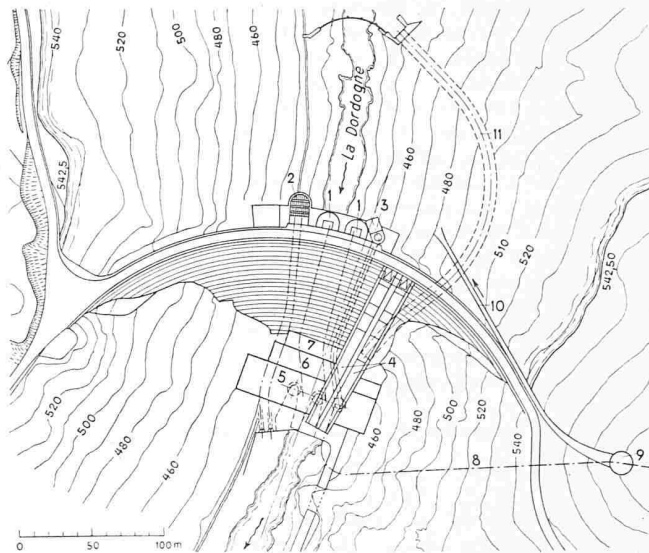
Kraftwerk Bort, Staumauer und Zentrale. Lageplan 1:5000
